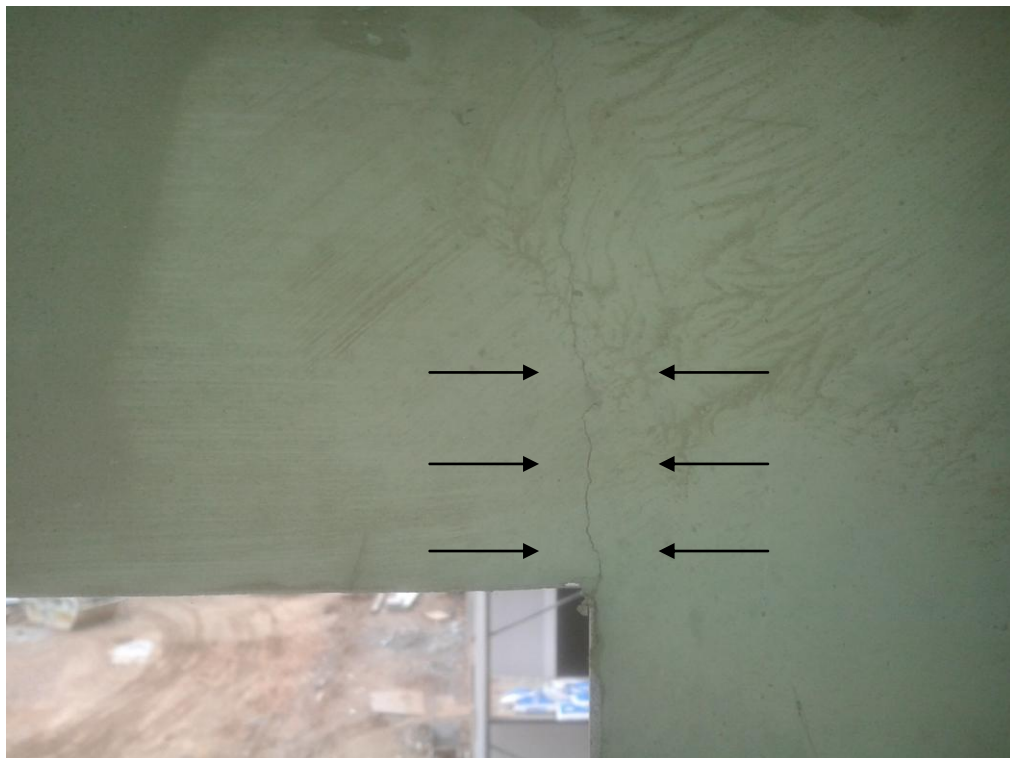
Fissura 90°: Fissuras a 90° de aberturas de portas e janelas
